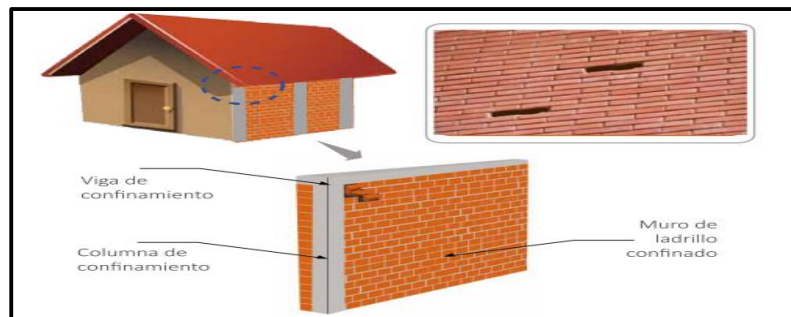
Imagen de reparación de fisuras en muros.
